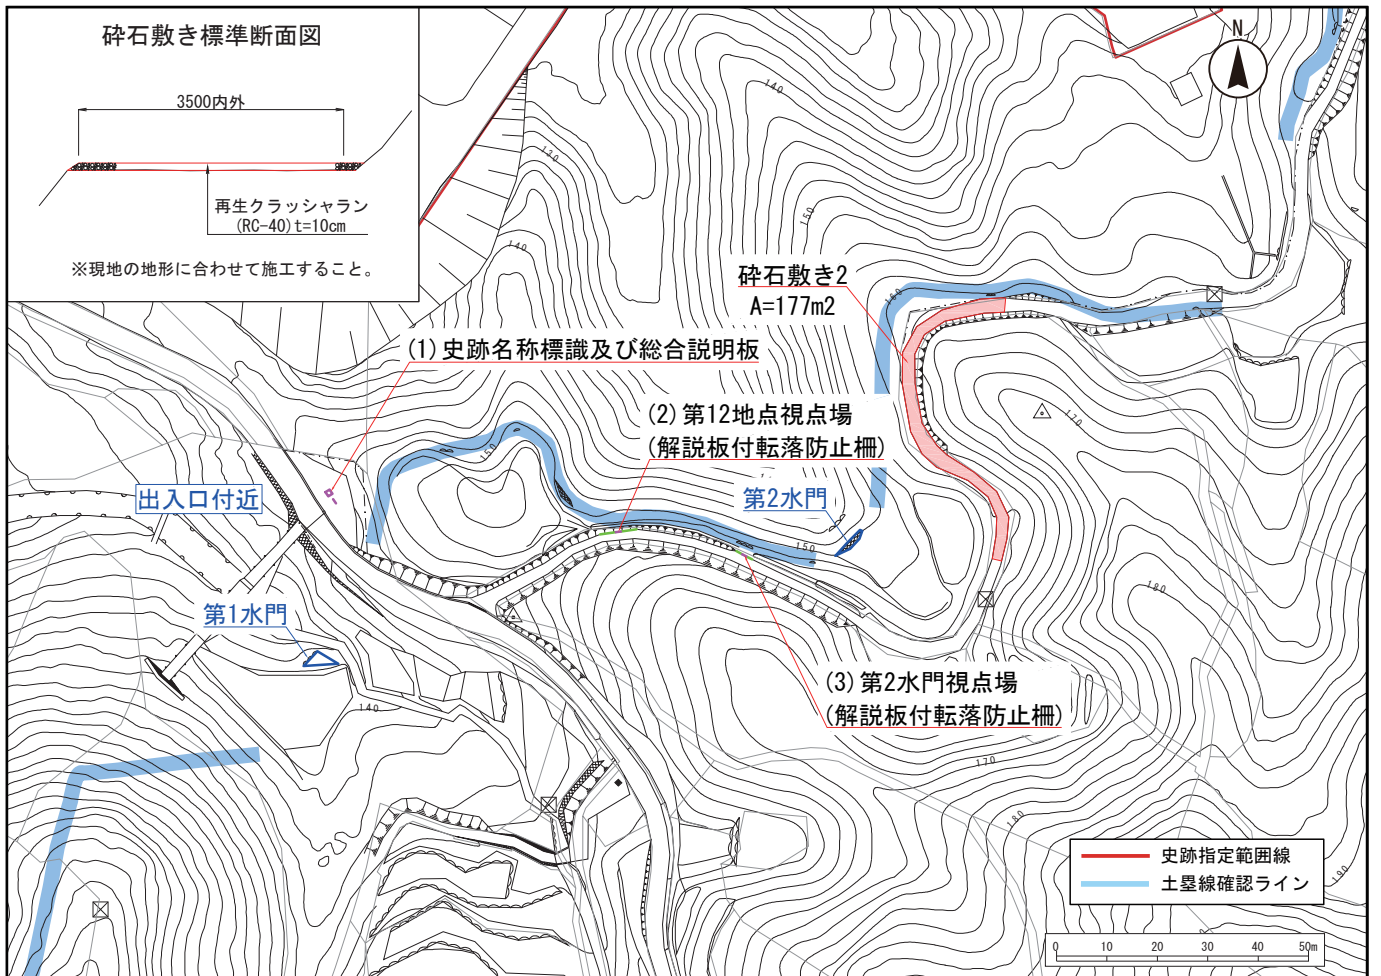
碎石敷き 2 計画平面図 (案) (1/1,500)
